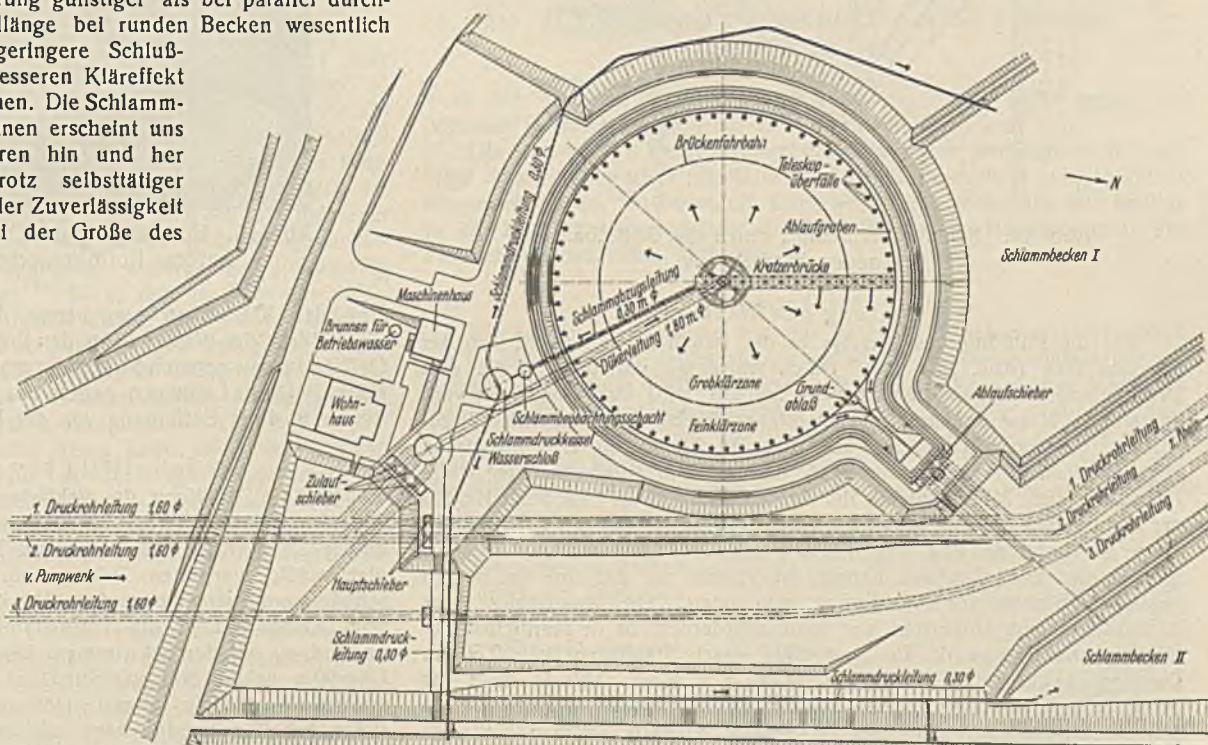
Lageplan der neuen Kläranlage mit dem zunächst ausgeführten einen Klärbecken von 68 m Durchm.
